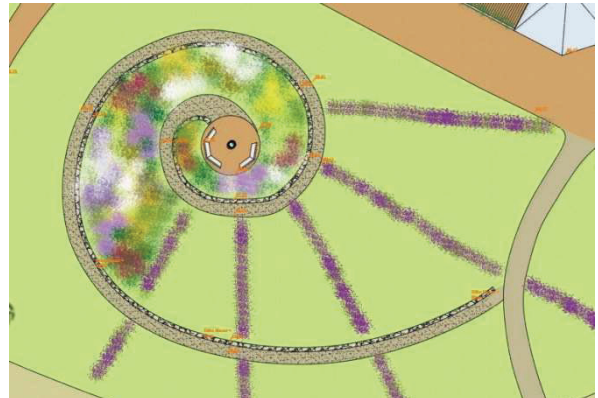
Kräuterspirale mit Barfußpfad und Lavendelbeeten, Ausschnitt aus dem Lageplan
